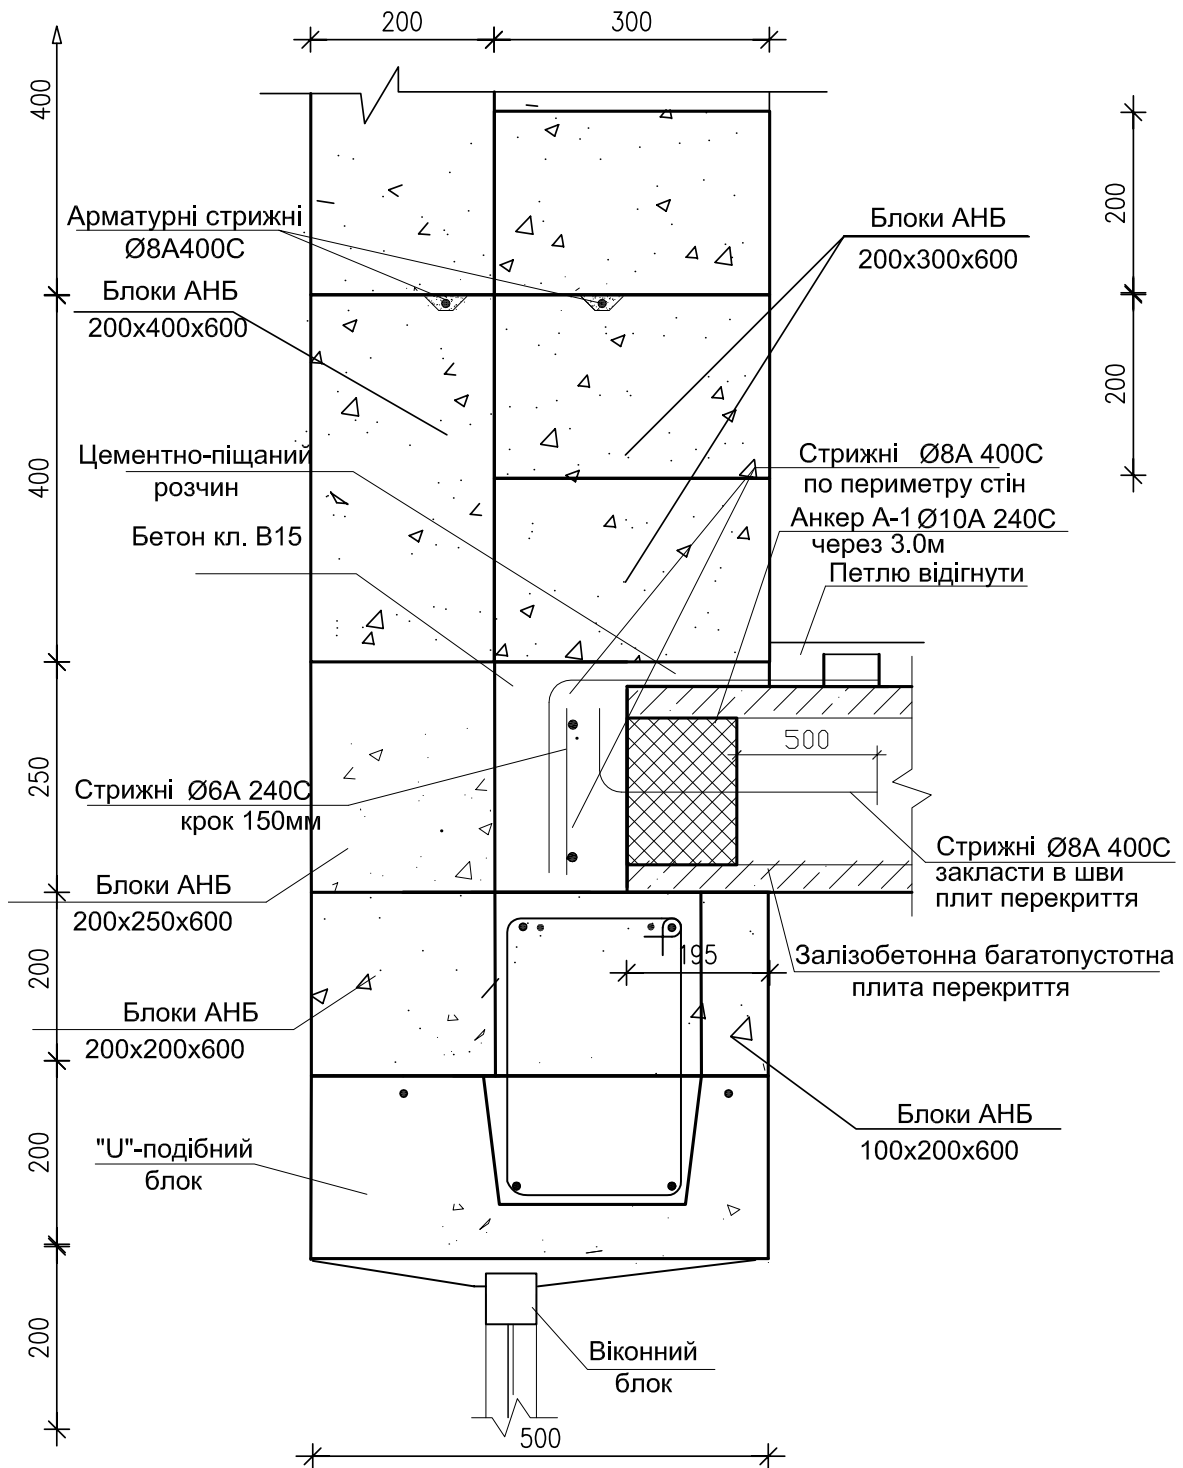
Двошарова стіна другого типу. Вузол спирання плити перекриття. Перетика над великим отвором
